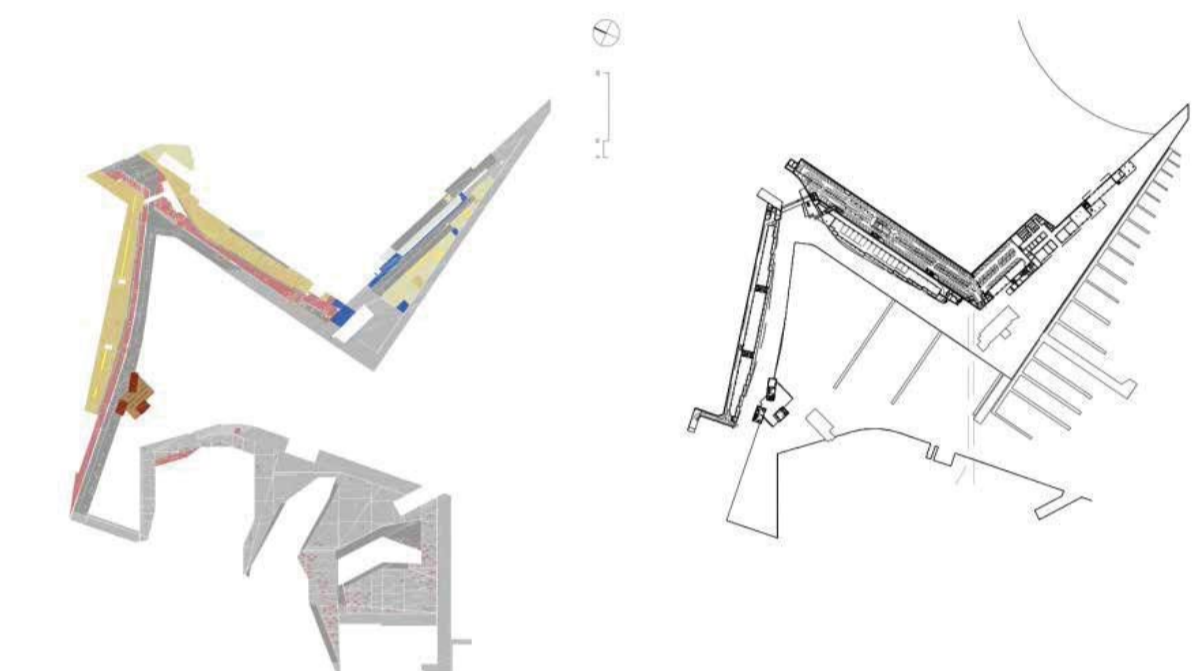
Planimetría Cielos y espacios - Proyecto Puerto Deportivo en Sant Adrià de Besòs / www.plataformaarquitectura.cl
